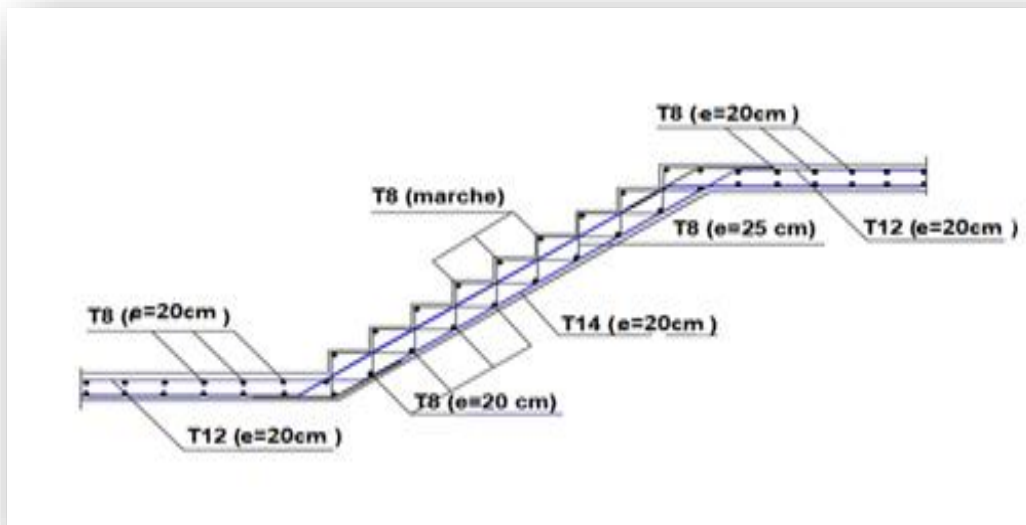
Schéma de ferrailage de l'escalier (volée et 3).
